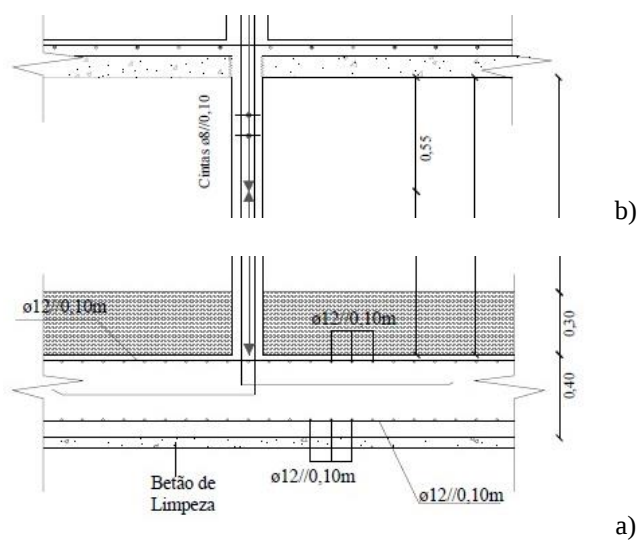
Detalhe de armadura das paredes resistentes: a) ligação à laje de ensaleiramento; b) atravessamento da armadura ao nível da laje existente
